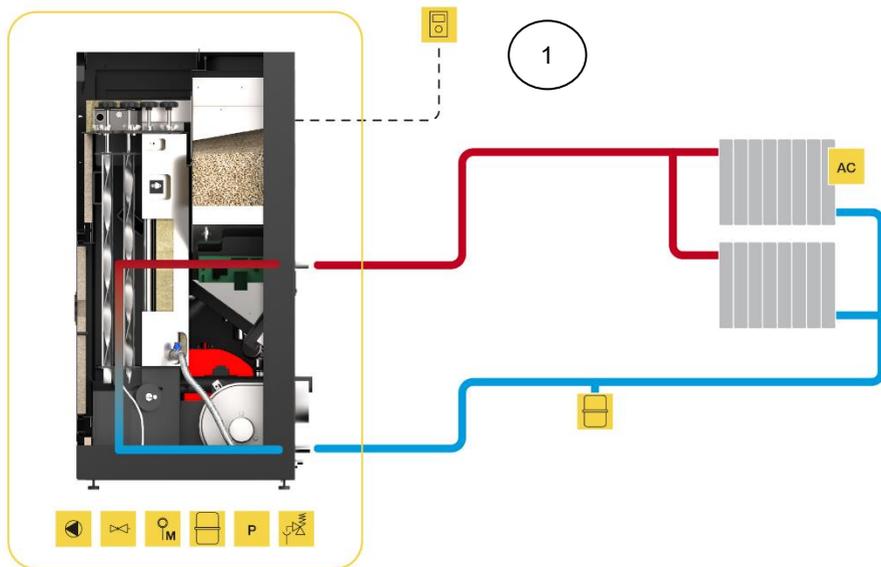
Ligação simples apenas a radiadores de aquecimento central
